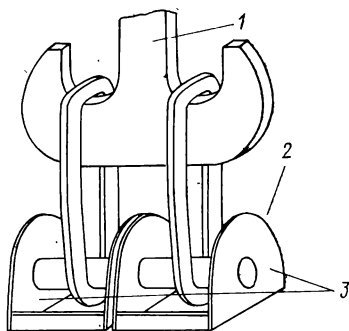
Грузозахватное приспособление для тяжеловесных конструкций.
